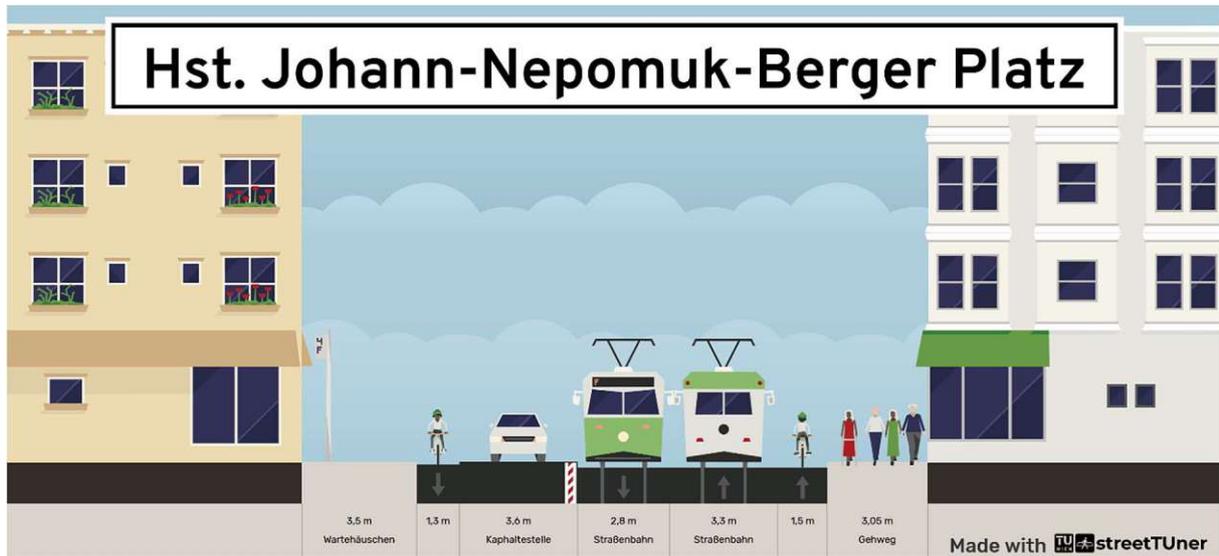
Querschnitt Haltestelle Johann-Nepomuk-Berger Platz. Quelle: TU Wien – StreetTuner (streettuner.fvv.tuwien.ac.at)
